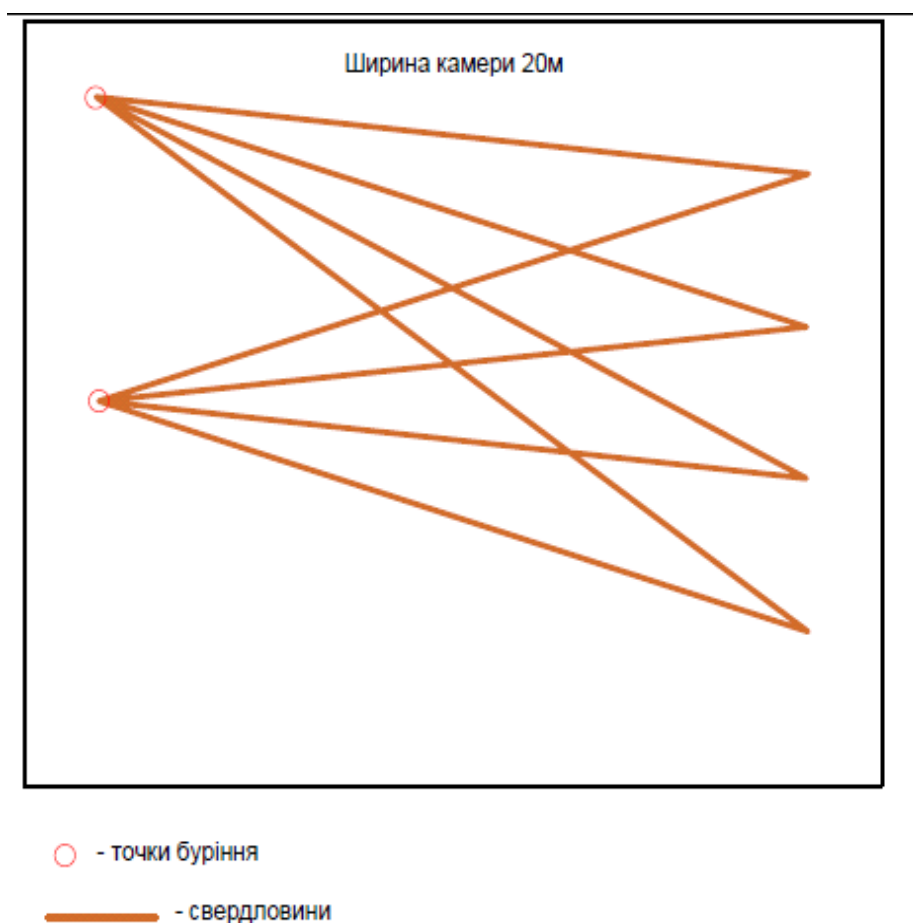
Схема розташування свердловин при відбійці руди
